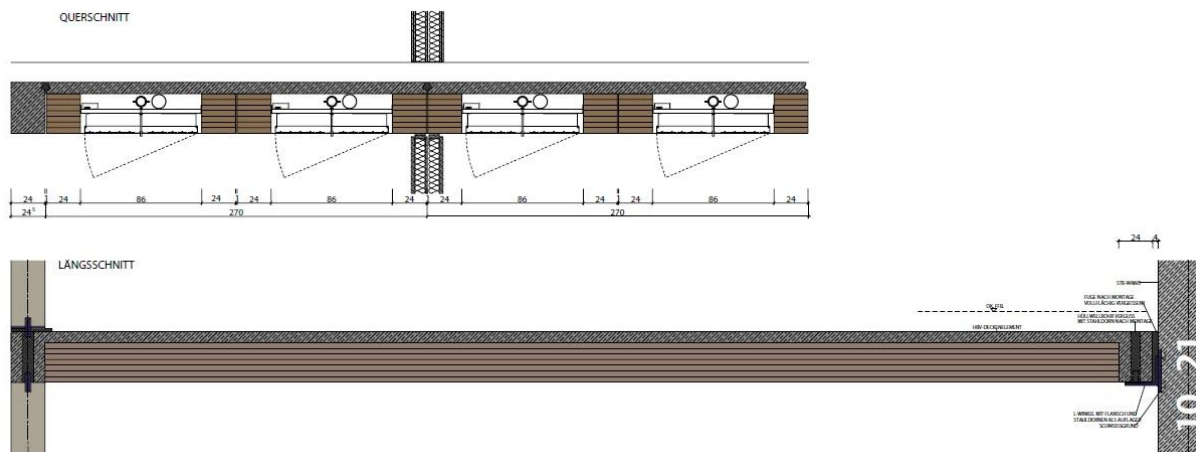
Schnitt durch die Holz- Beton- Verbundrippendecke des Lifecycle Tower [63]
